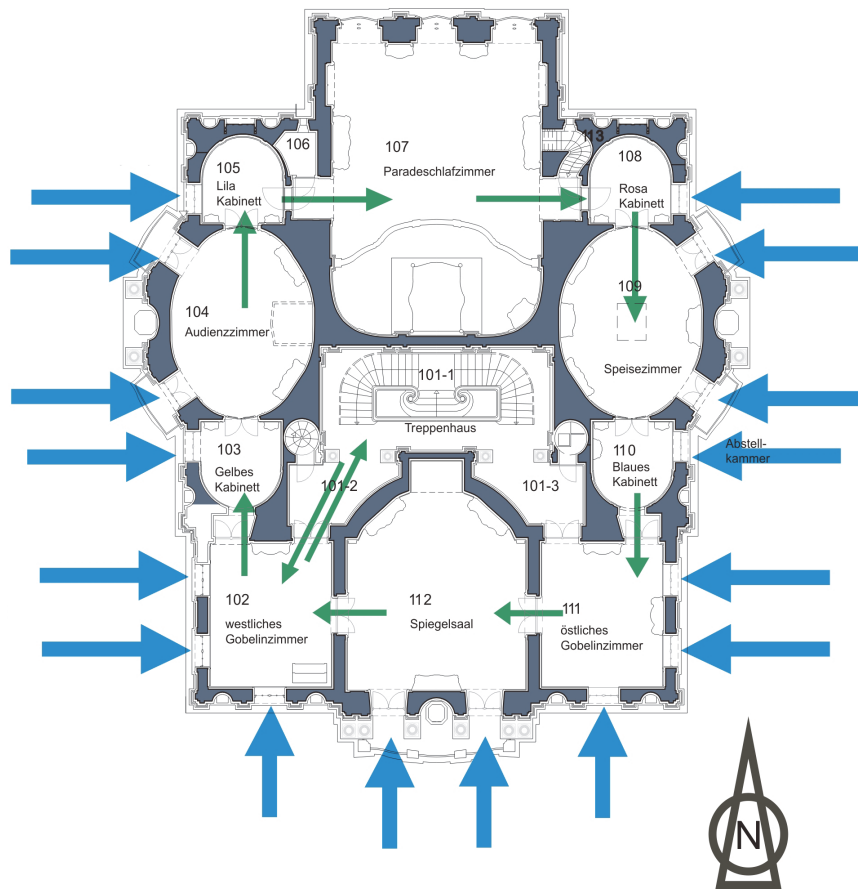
Obergeschoss mit Führungsrouten und Lüftungsmöglichkeiten im Grundriss nach [Bichlmair 2011b]. Die grünen Pfeile zeigen den Weg entlang der Führungsrouten, die blauen Pfeile die zur Lüftung verwendeten Fenster. (Planmaterial Bayerische Schlösserverwaltung).
